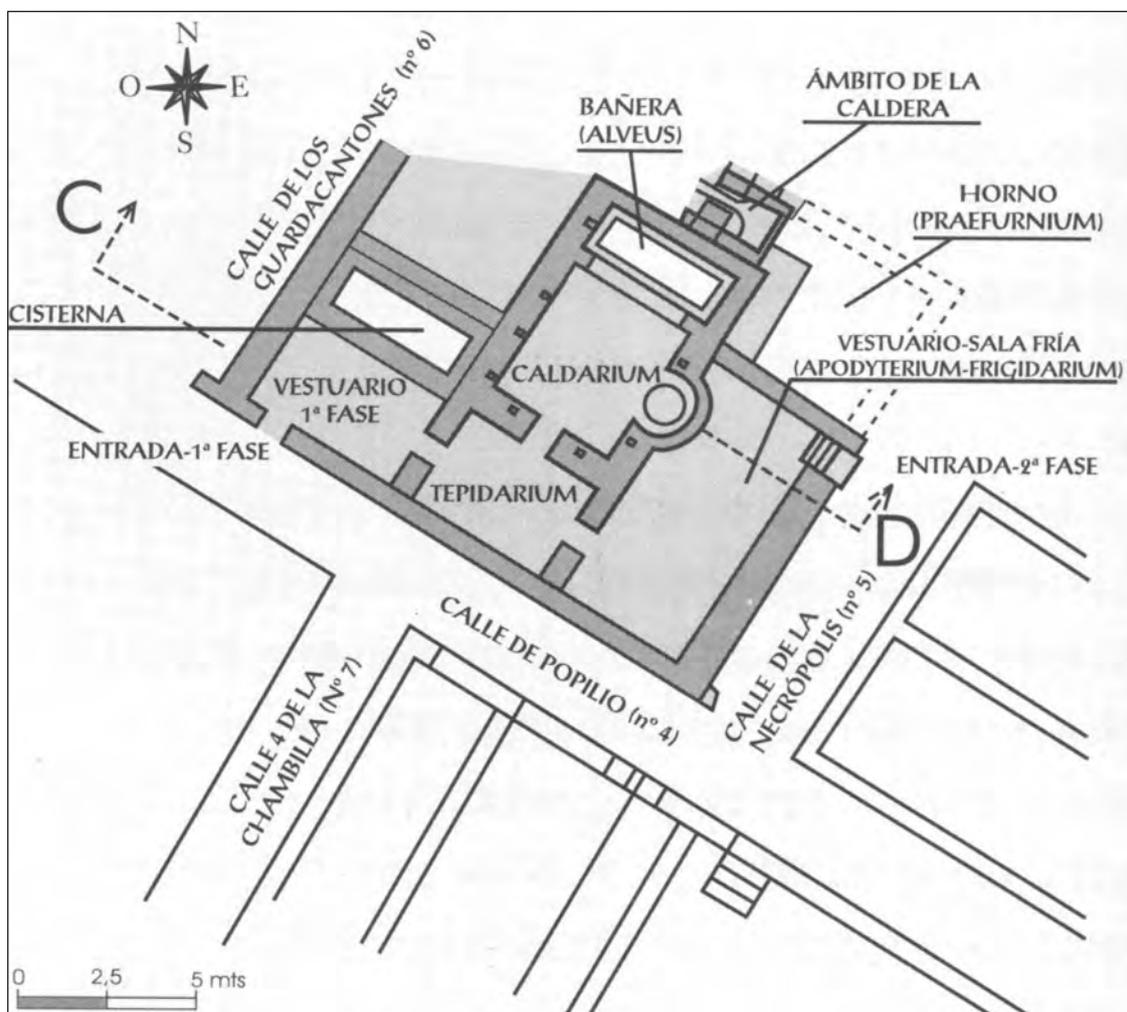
Planta de las termas de Popilio (Olcina Doménech, 2007)
